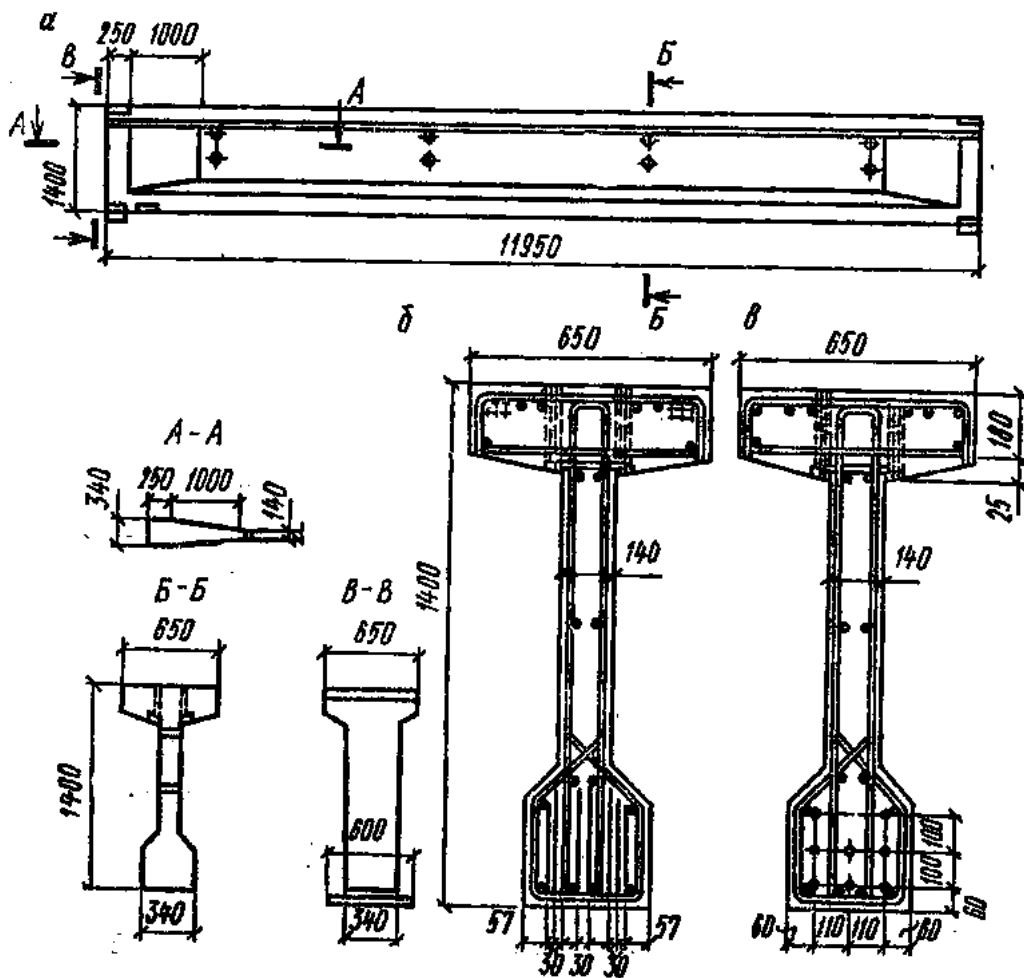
Конструкция предварительно напряженной подкрановой балки пролетом 12 м:
